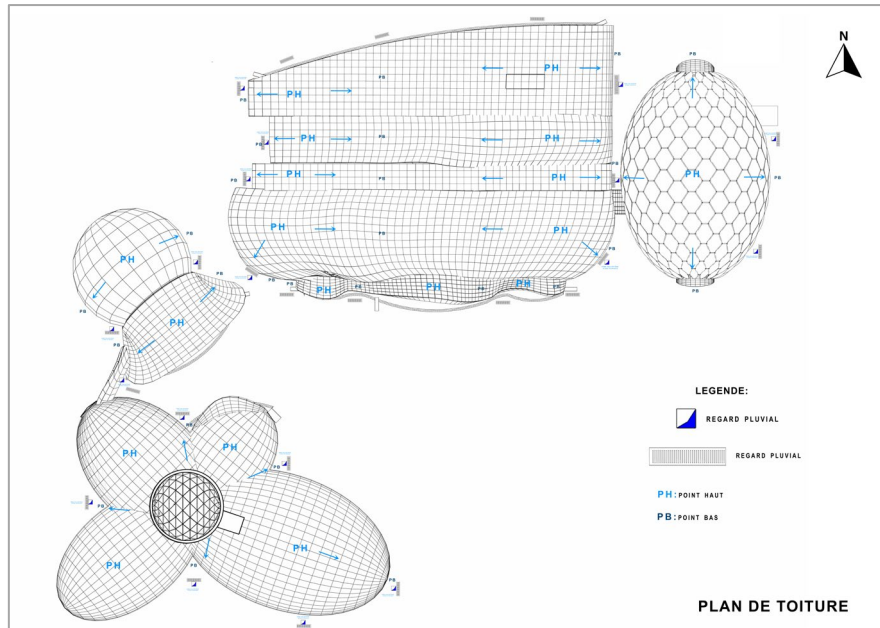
plan de toiture et collecte d'eau pluviale (Voir annexe).
